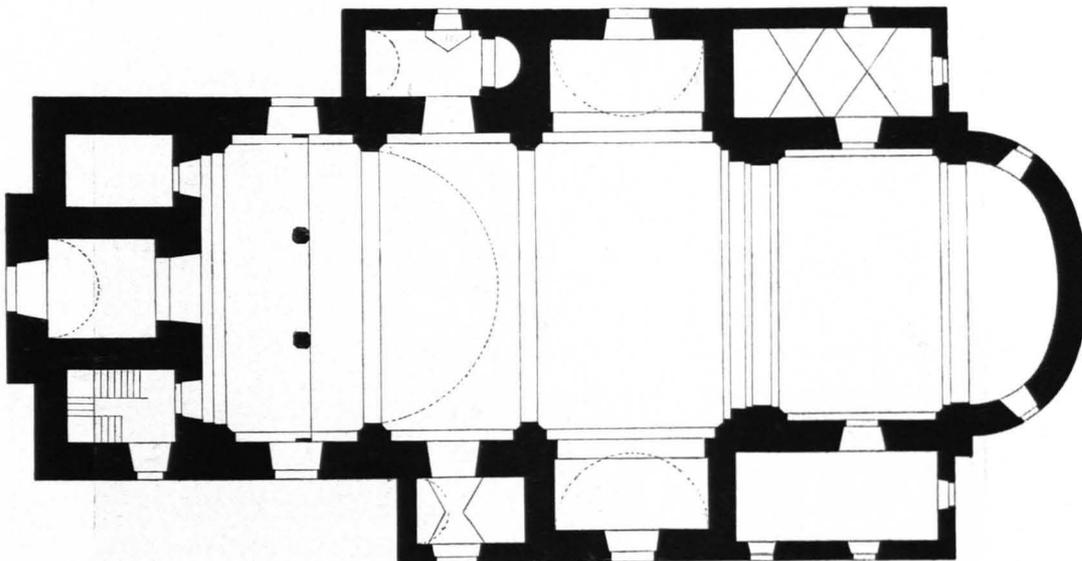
Röschitz, Pfarrkirche, Grundriß 1:300 (S. 107)
